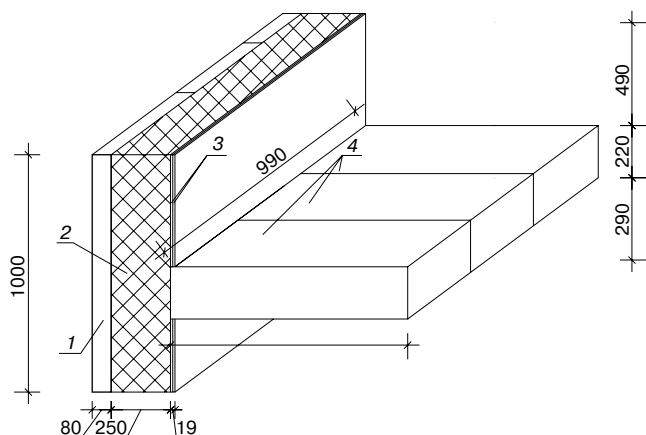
Общий вид экспериментального фрагмента стены с перекрытием: 1 – фасадная панель; 2 – пенополистирол; 3 – два слоя ГКЛО; 4 – ж/б плита перекрытия. Условная вертикальная плоскость симметрии фрагмента проходит через середину монтажного крюка, а верх шпонки размещен от верха фрагмента панели на расстоянии 400 мм
